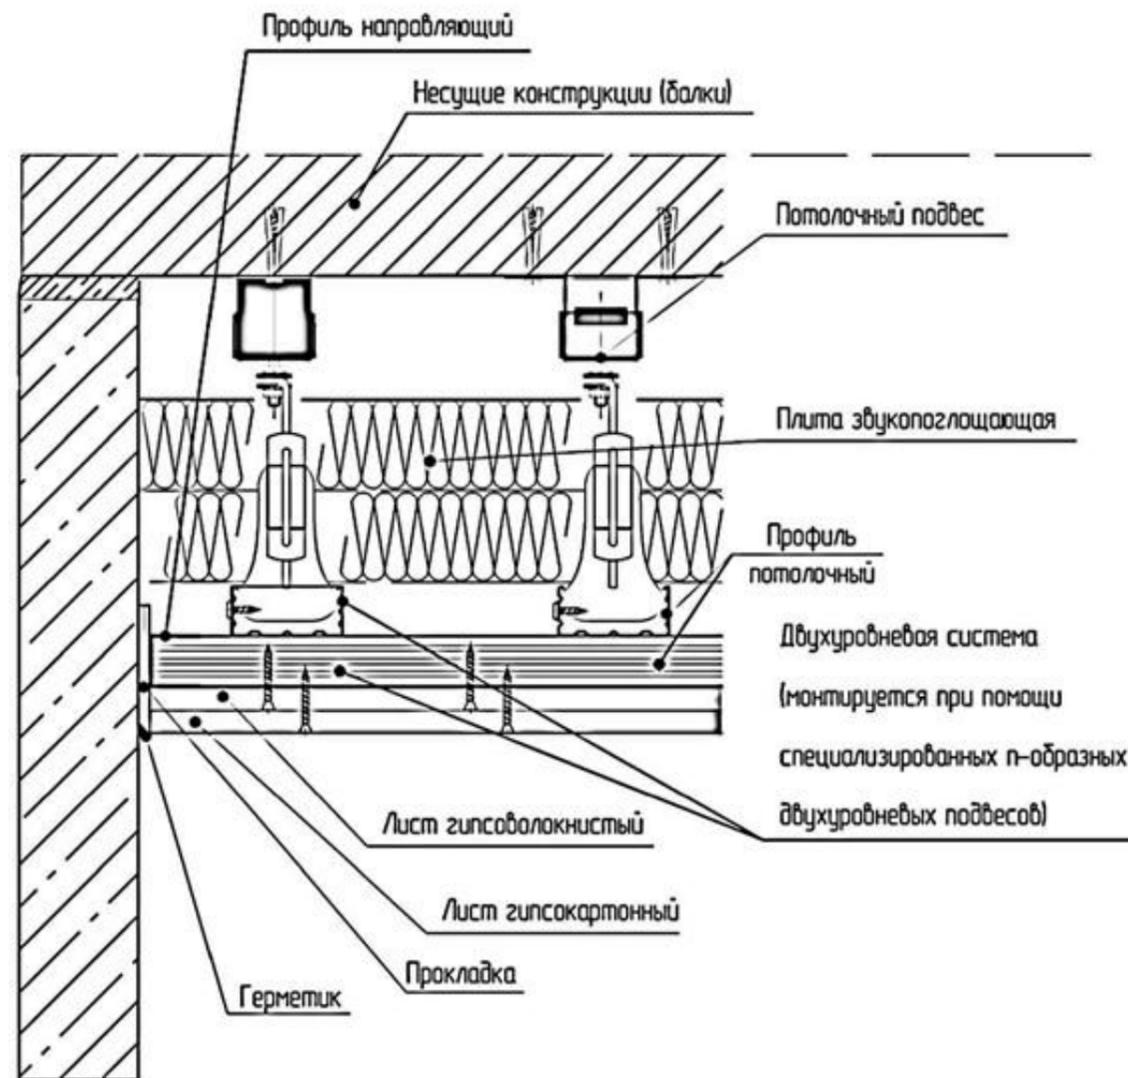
Каркасная конструкция дополнительной звукоизоляции перекрытия
